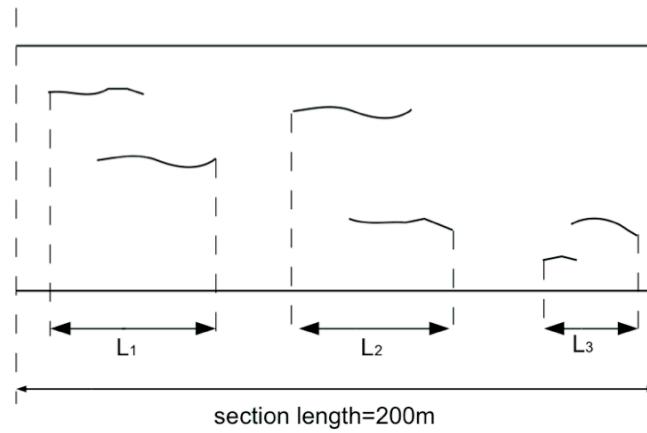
Pourcentage de fissuration longitudinale d'une section de longueur 200m :
